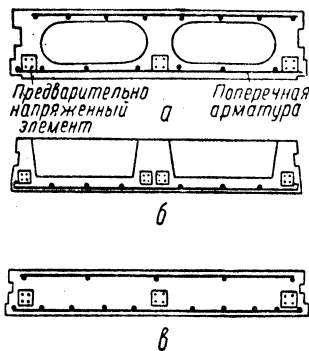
Армирование предварительно напряженными элементами панелей: а — многпустотный; б — ребристой; в — сплошной.
